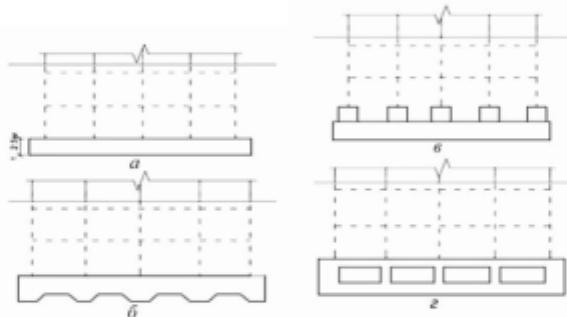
Конструкции сплошной монолитной железобетонной плиты
